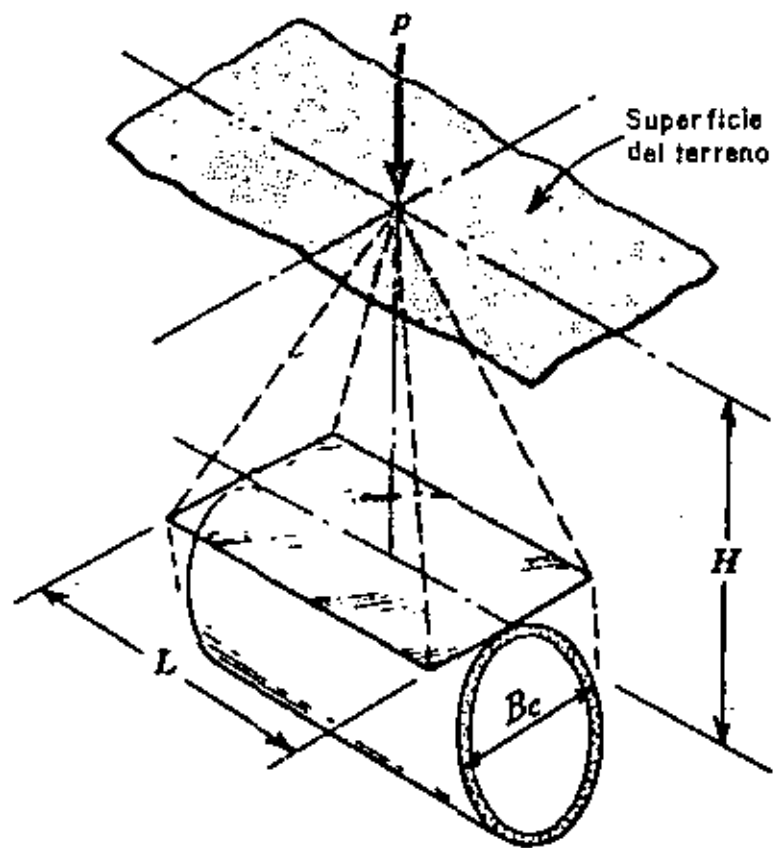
CARGA CONCENTRADA SOBREPUESTA CENTRADA VERTICALMENTE SOBRE EL CONDUCTO.
